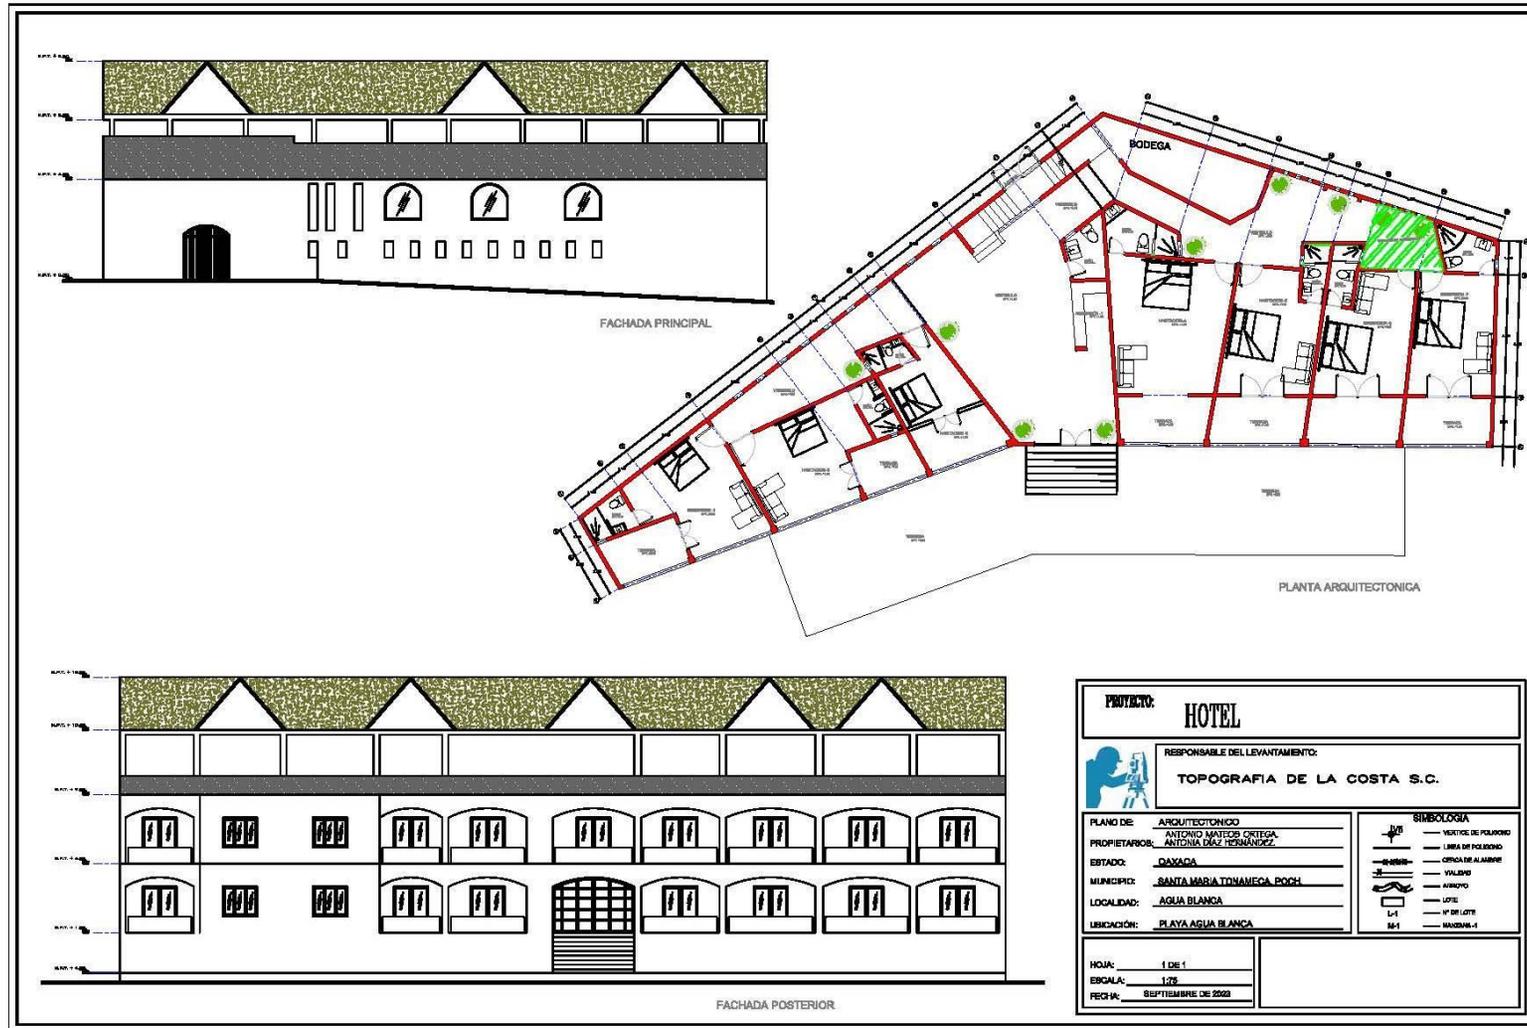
Plano de ubicación de las obras sancionadas por la PROFEPA.
